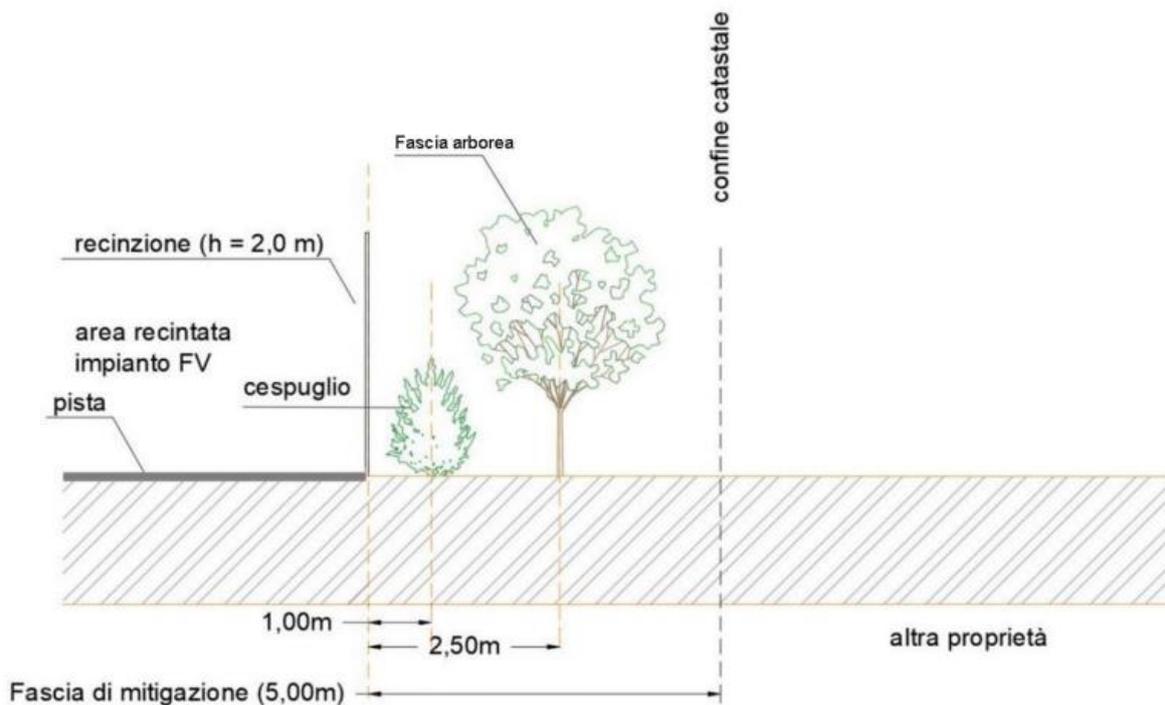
Fascia di mitigazione tipo : pianta e sezione
